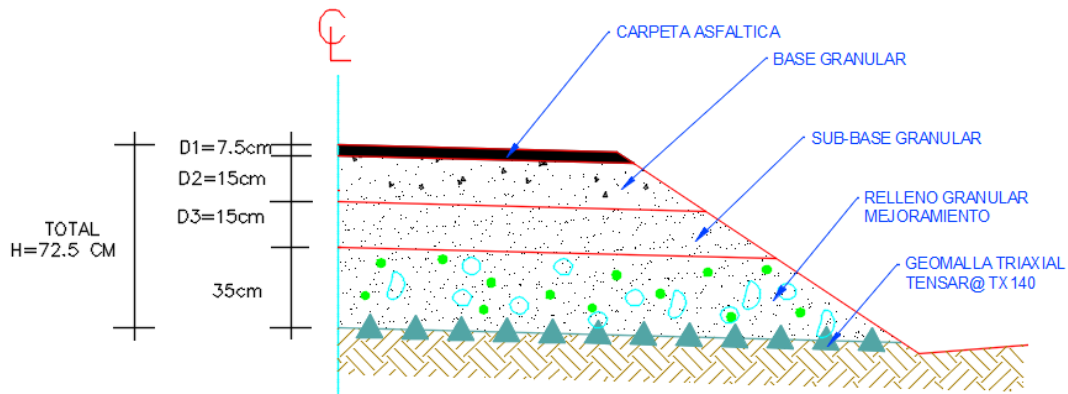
Paquete Estructural Obtenido con Refuerzo de Geomalla
